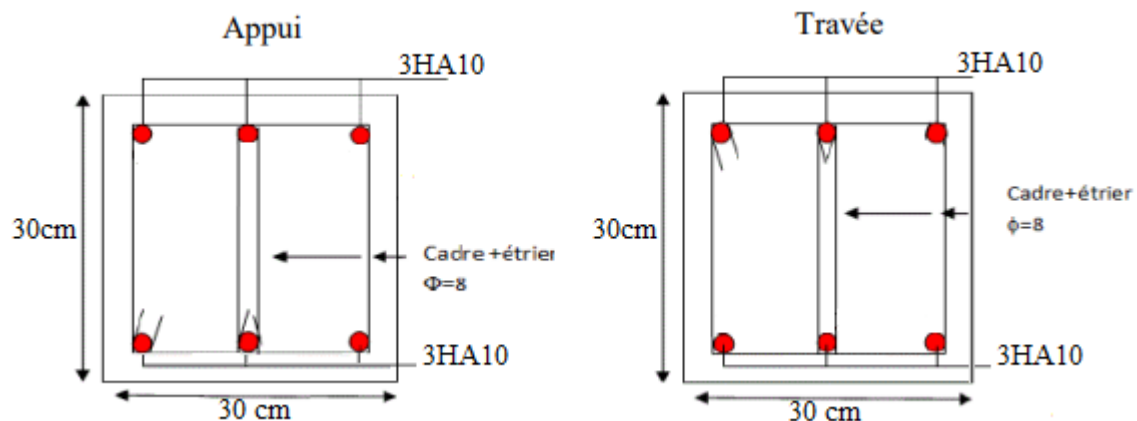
Schéma de ferrailage de la poutre de chaînage
